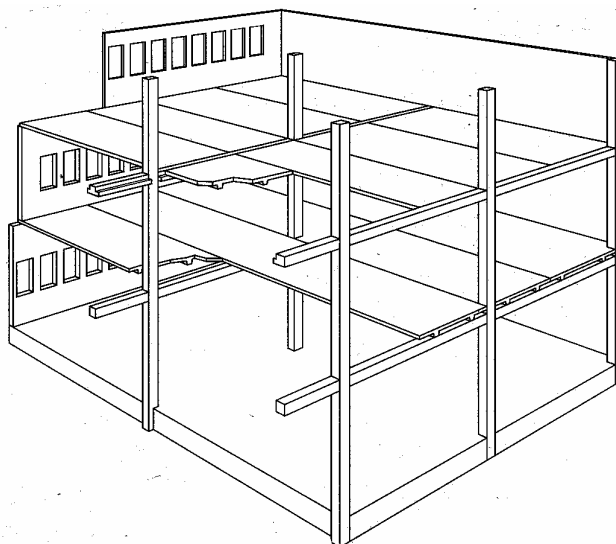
exemplo de um edifício para escritórios com estrutura em esqueleto e com fachadas em concreto arquitetônico.
